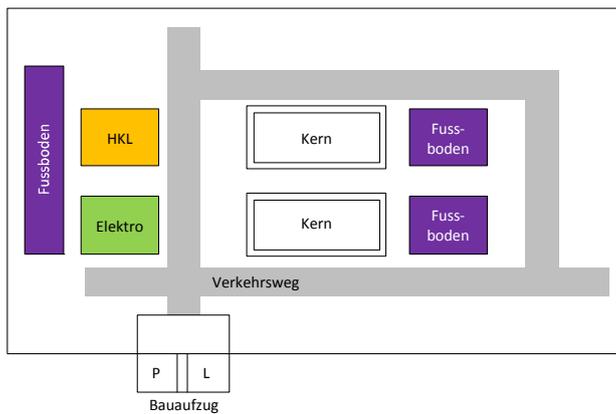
Stockwerkklagerplan – Ausbau III: Fussboden, HKL/E-Armaturen
